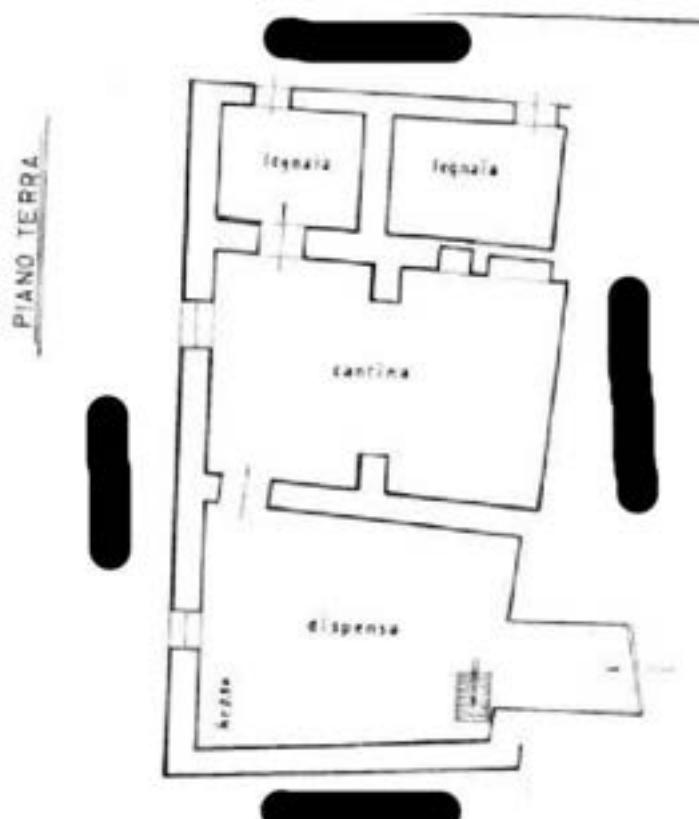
Planimetria particella 21 sub 1- Piano terra
